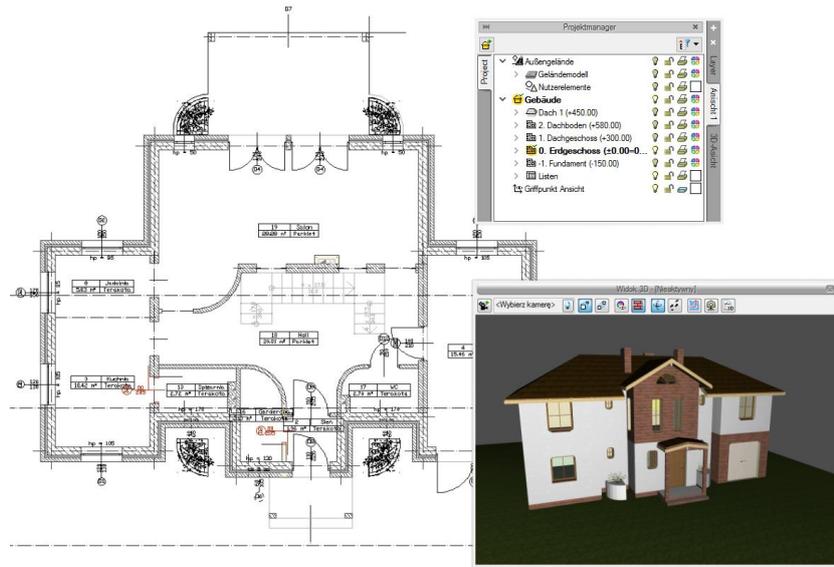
Beispiel mit aktiver Ansicht Grundriss 1
